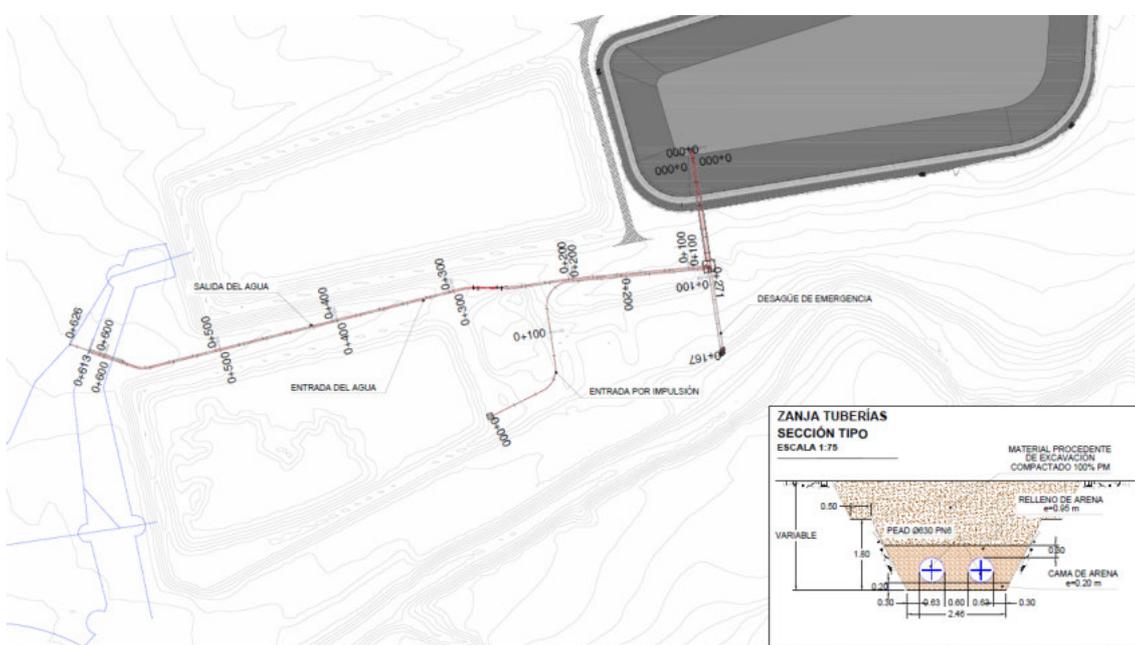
Esquema en planta de las conducciones, así como la sección tipo de las zanjas. Fuente: Elaboración propia
